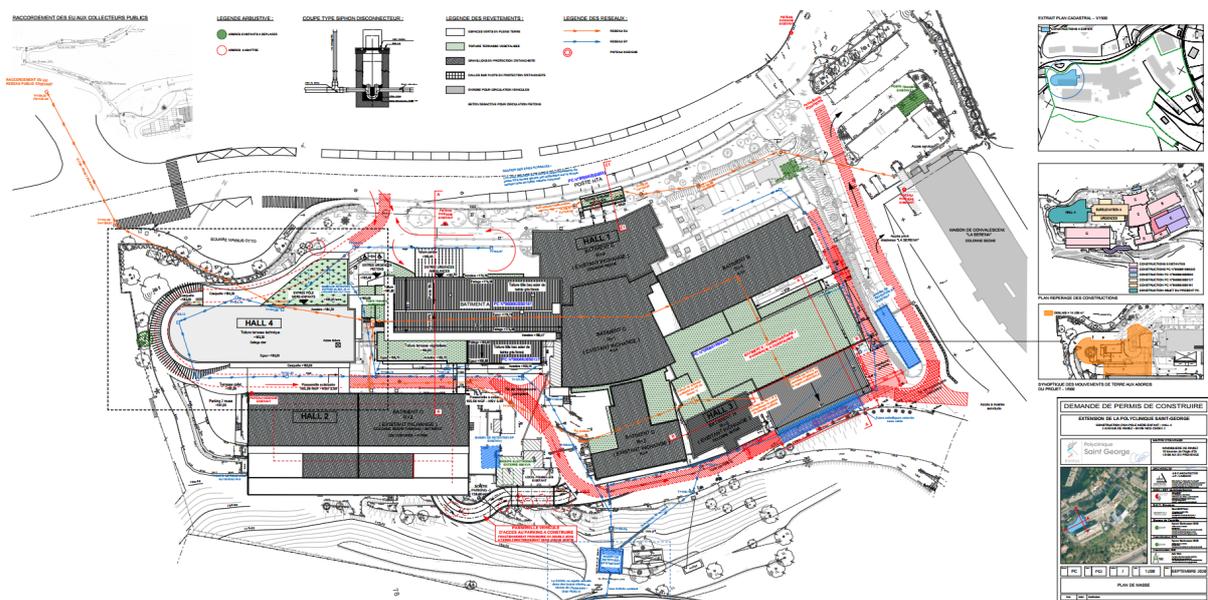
Plan masse du projet (Source : PC Septembre 2020) (cf. Plan en annexe)
